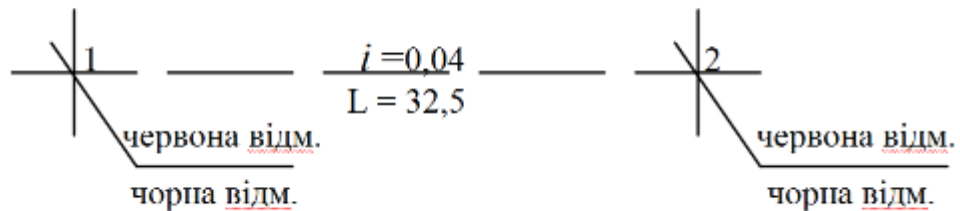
Фрагмент позначень на схемі вертикального планування.
